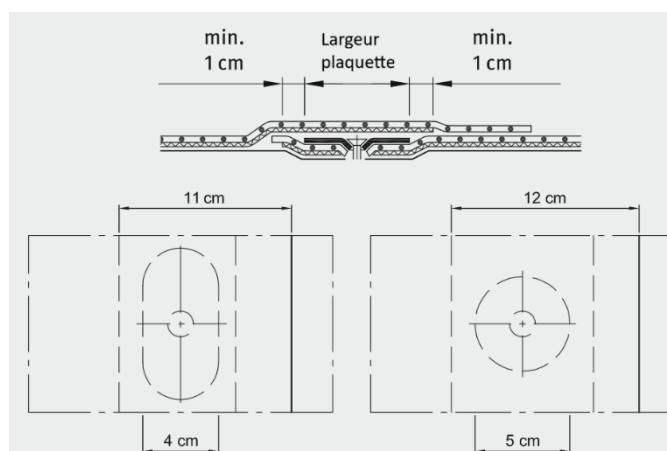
Joints longitudinaux en cas de système fixé mécaniquement
